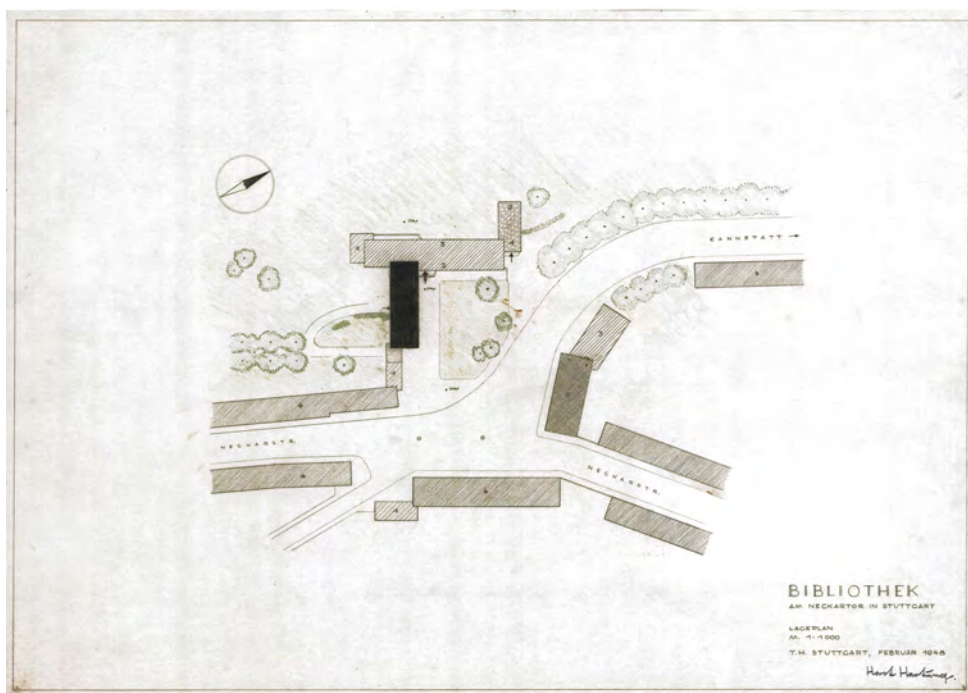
Sechster Entwurf „Bibliothek am Neckartor“, Lageplan
